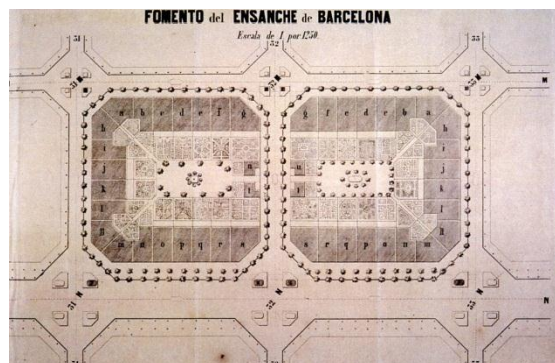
Detalls geomètrics en planta de dues illes del Pla Cerdà.
